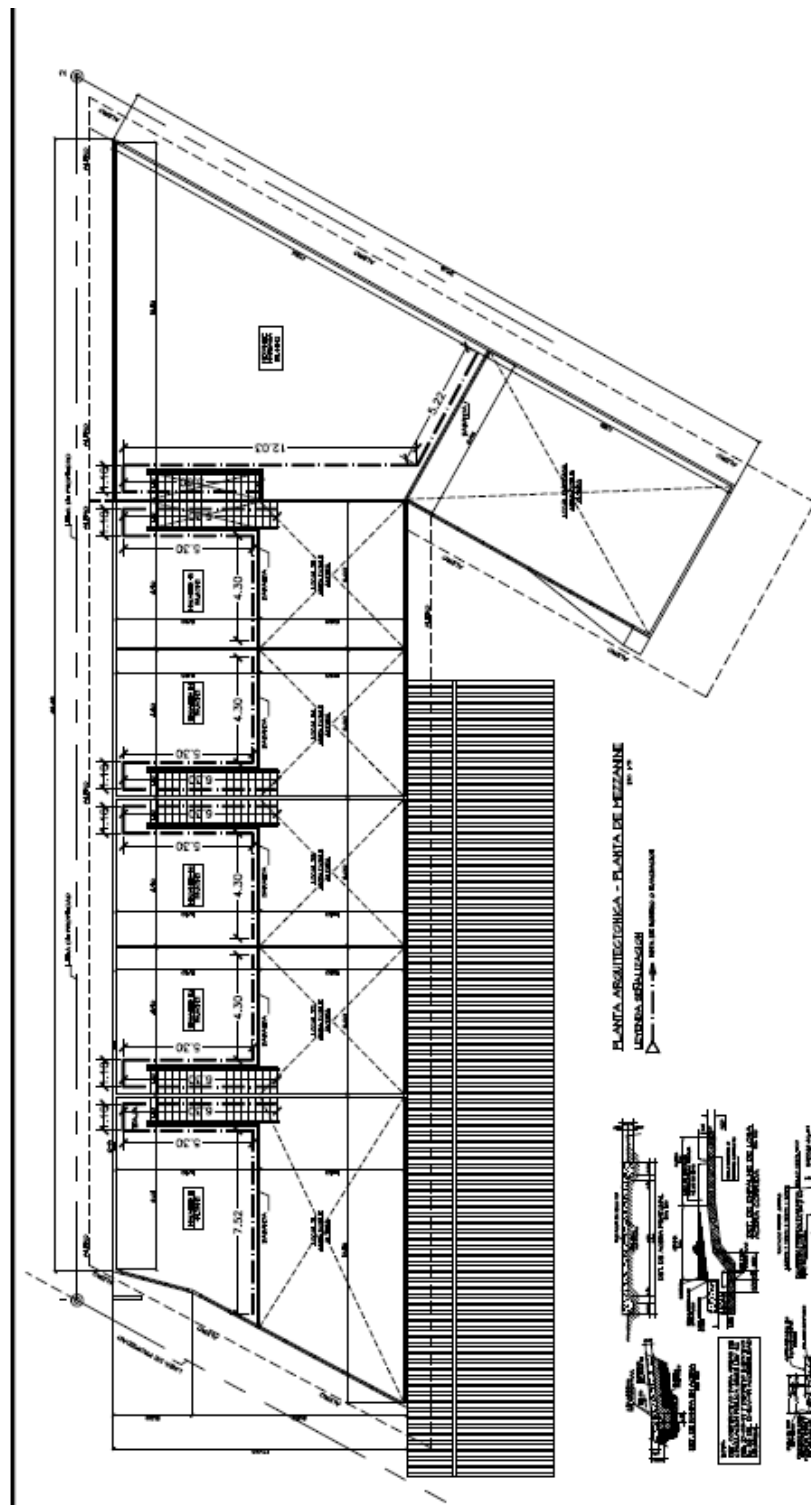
Planta Arquitectónica, Planta Mezzanine, del proyecto.
